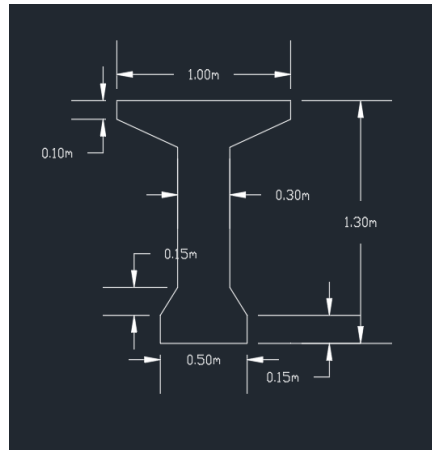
Coupe transversale d'une poutre en BA du tablier de la variante 1
